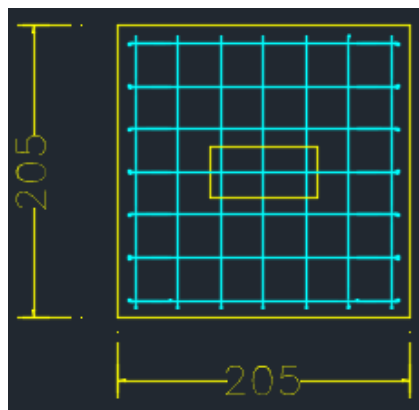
Distribución de aceros Zapata tipo II. Fuente planos estructurales
